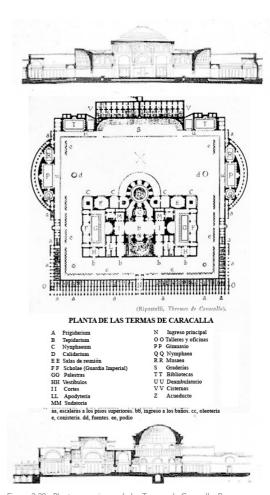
Planta y secciones de las Termas de Caracalla, Roma.
